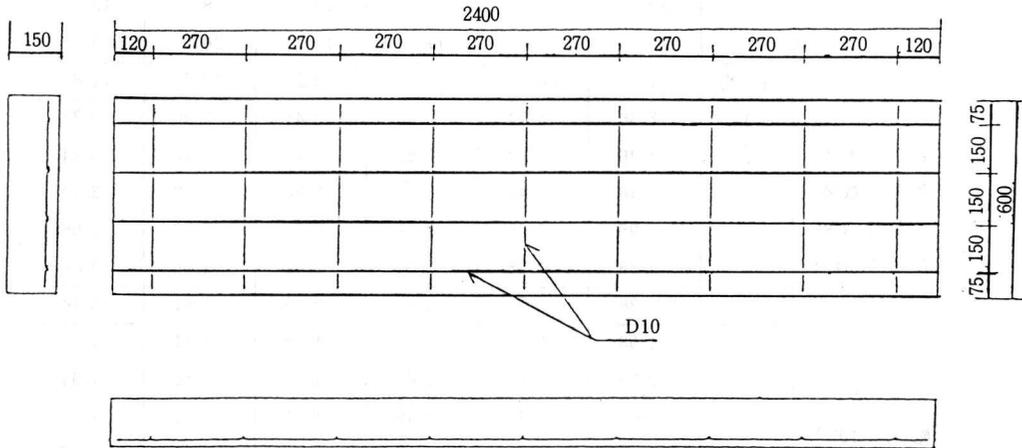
曲げクリープ試験体の形状・寸法及び配筋状況 (mm)
